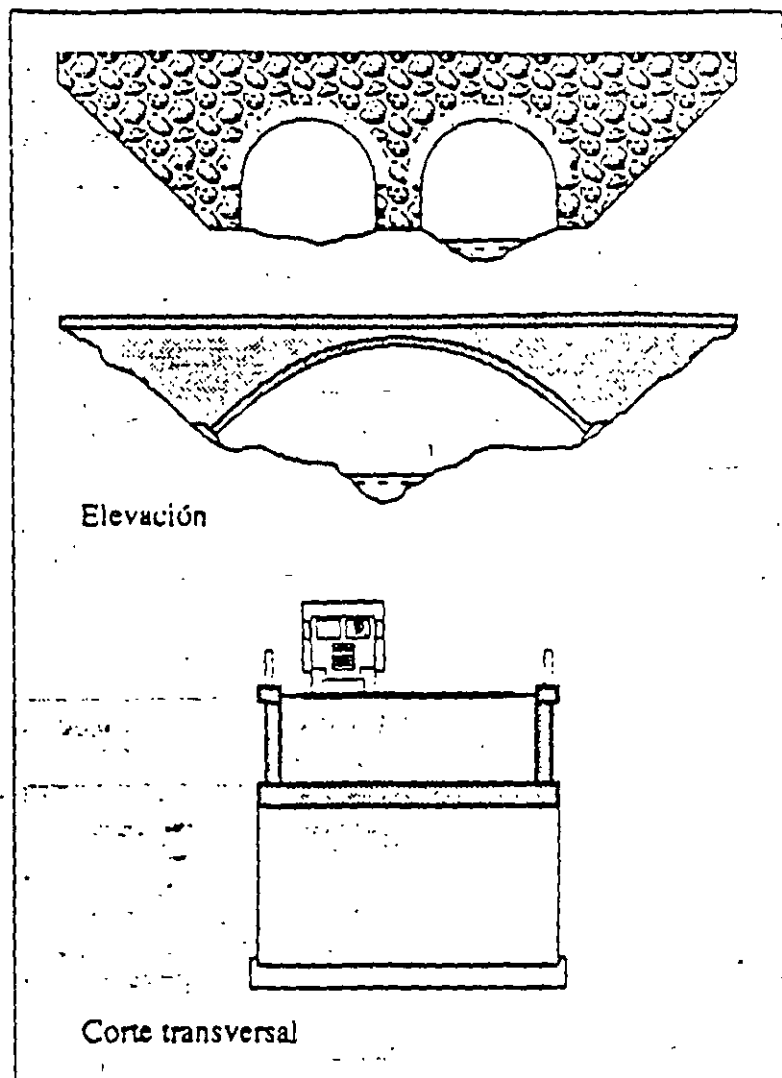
Sección transversal, tipo 52, Arco Inferior, tipo cerrado
